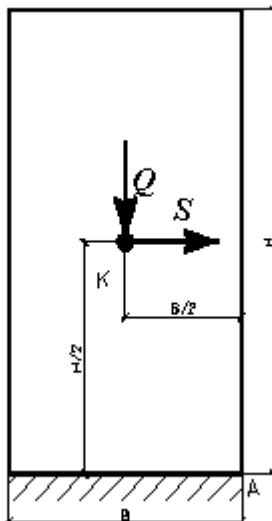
Расчетная схема здания рассчитываемого на опрокидывание
